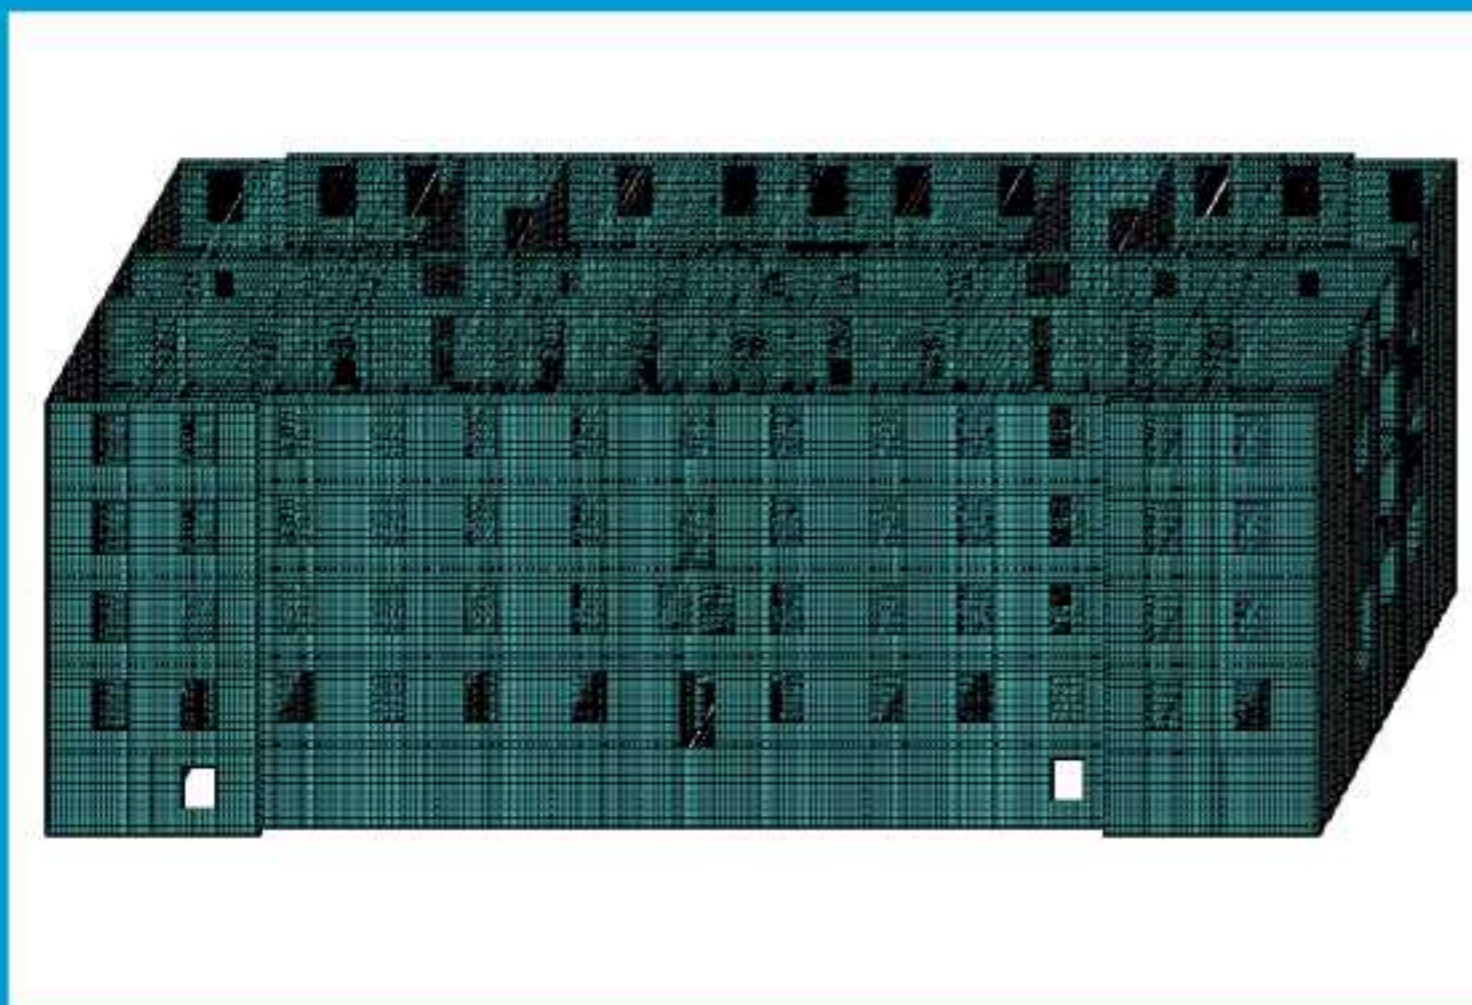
Розрахункова схема моделі будівлі з врахуванням надбудови додаткового поверху
